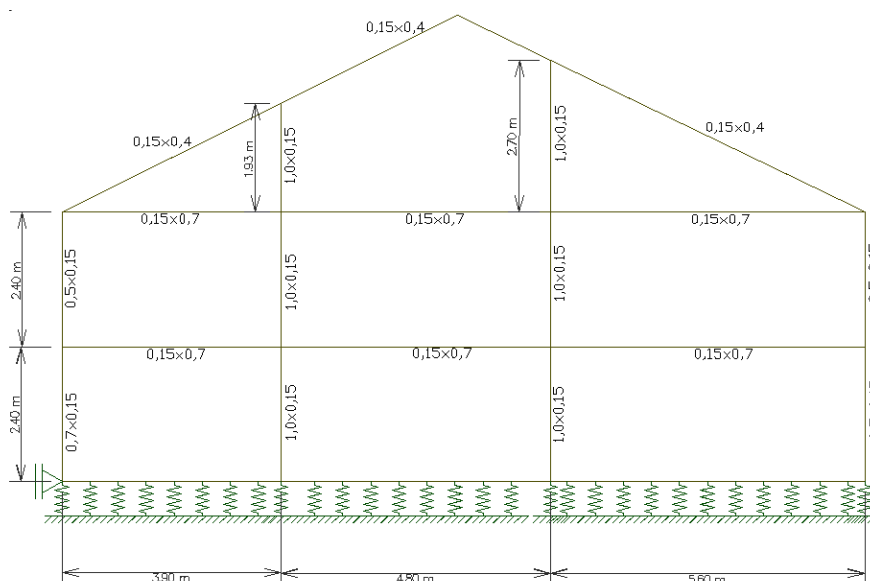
Dimensões e geometria das vigas e pilares do pórtico 2-2'
